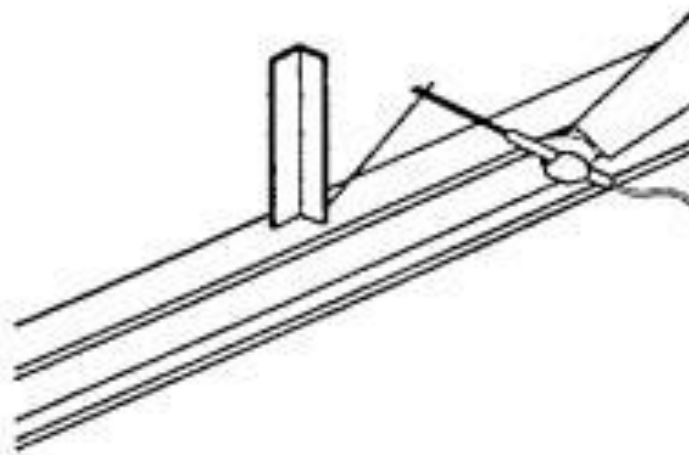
Крепление металлических стоек под торцевую опалубку и направляющие
